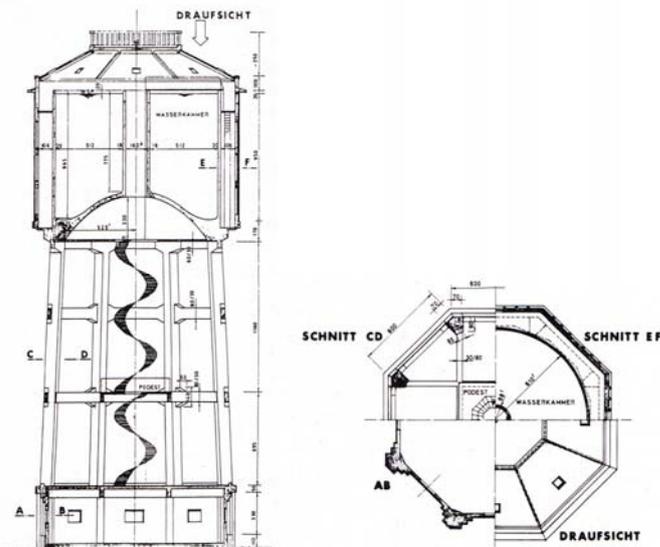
Wasserturm Blumau, Schnitt und Grundriss
